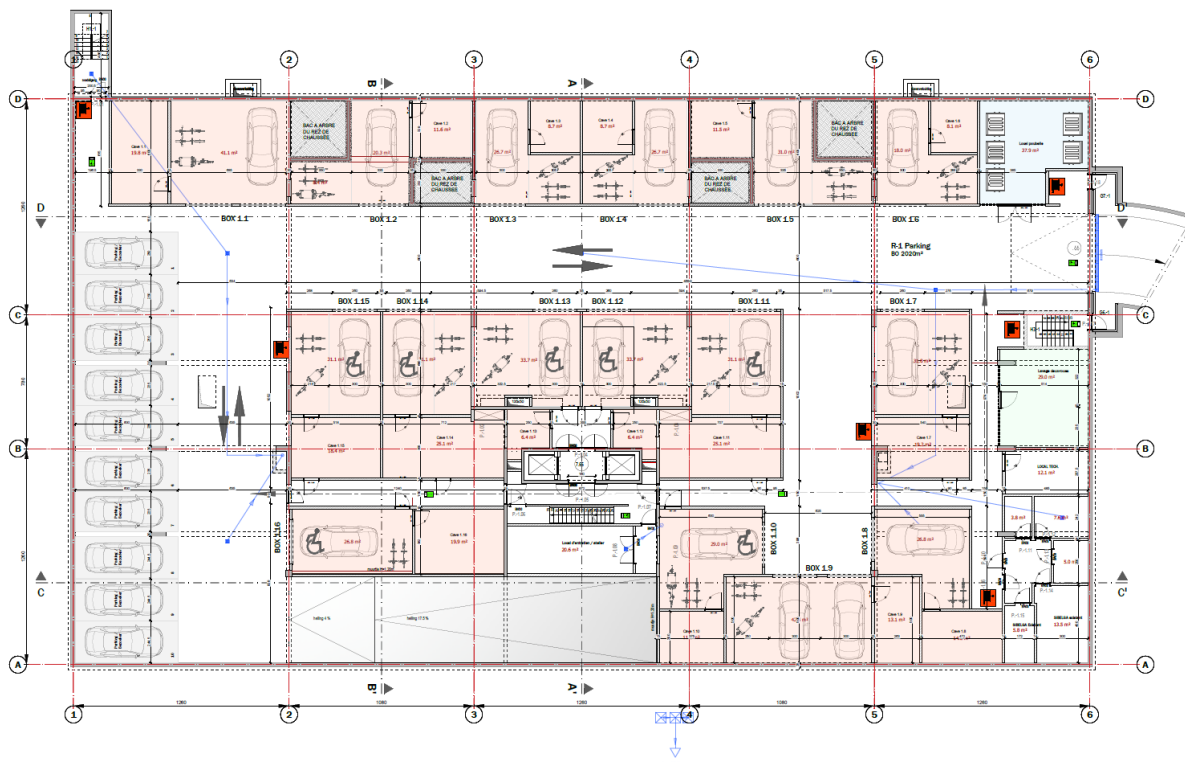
Extrait de plan du R-1 (source : ARTER Architects)
